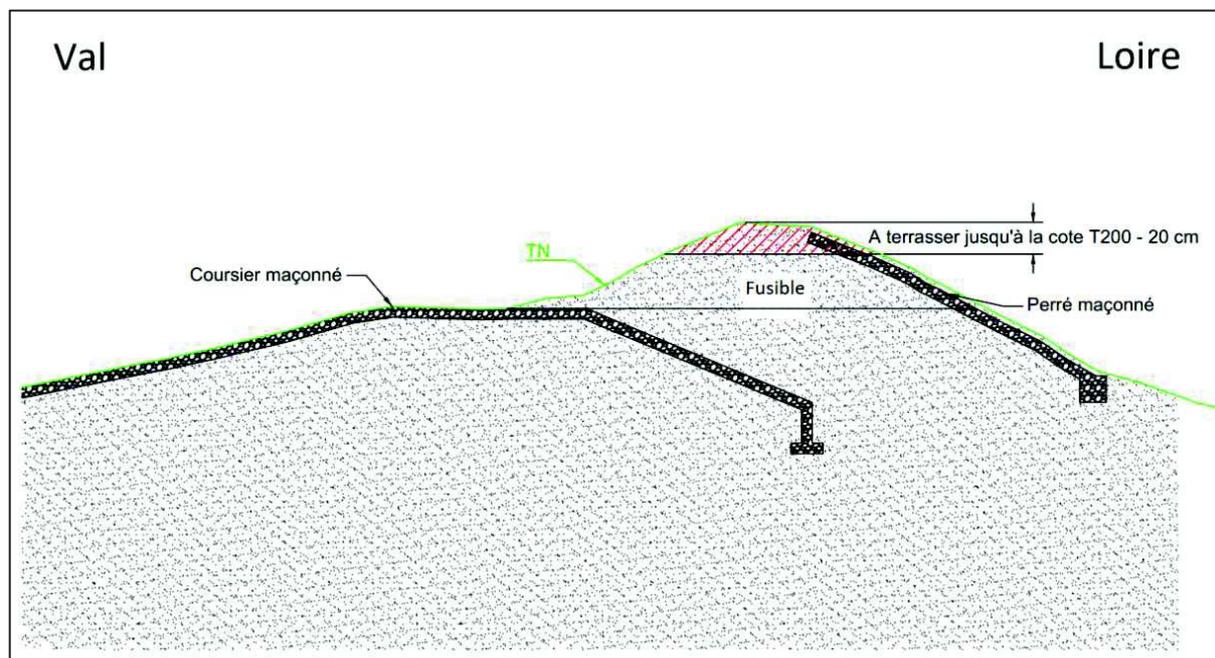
Coupe de principe des travaux – Opération 3 – Jargeau
